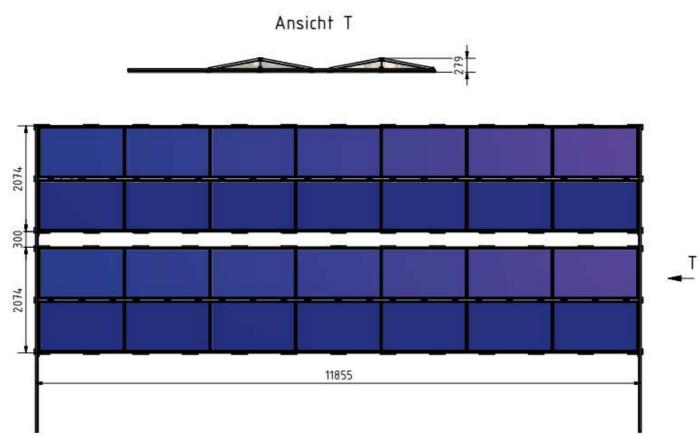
Hauptabmessungen (einschl. Sturmschienen) für zwei 7-fach Elemente
